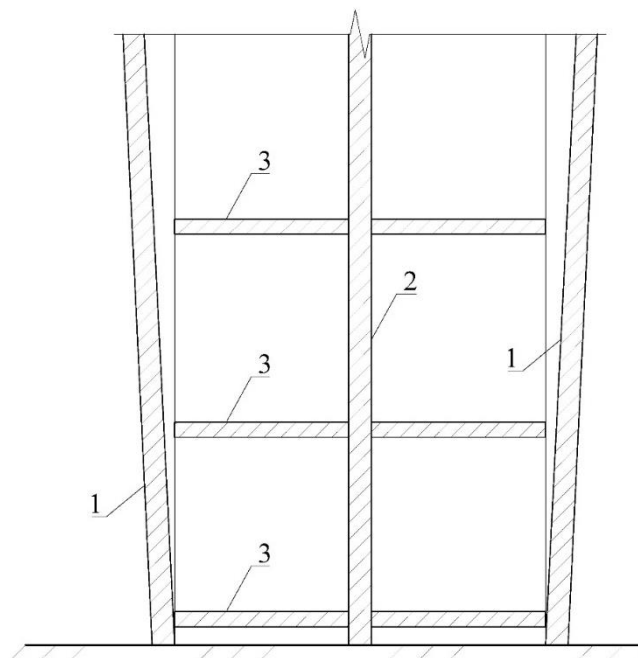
Принципиальная схема дефекта - крен стен: 1 – наружная стена, отклонившаяся от вертикали; 2 – внутренняя стена; 3 – перекрытие.
